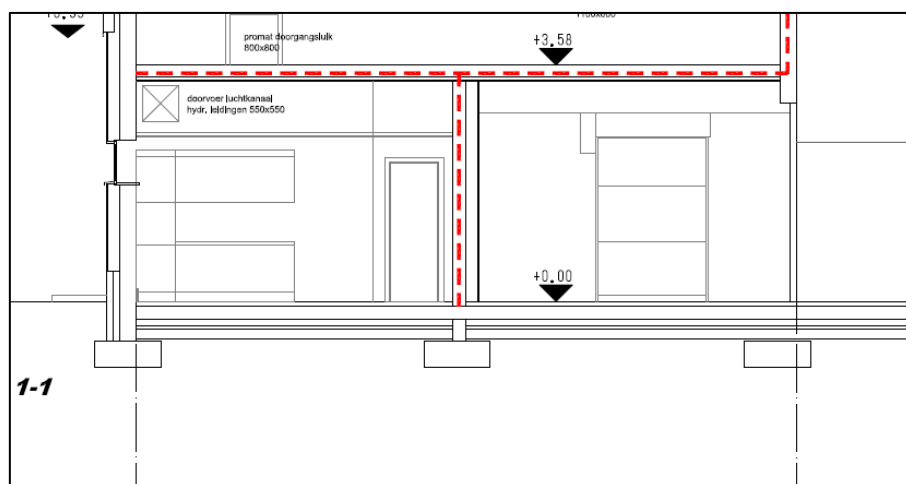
detail uit het doorsnedeplan met verduidelijking van de funderingsopbouw
